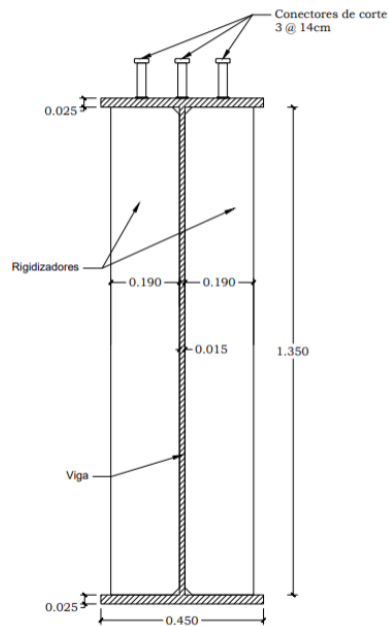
Detallamiento de viga de acero. Fuente: Elaboración propia
